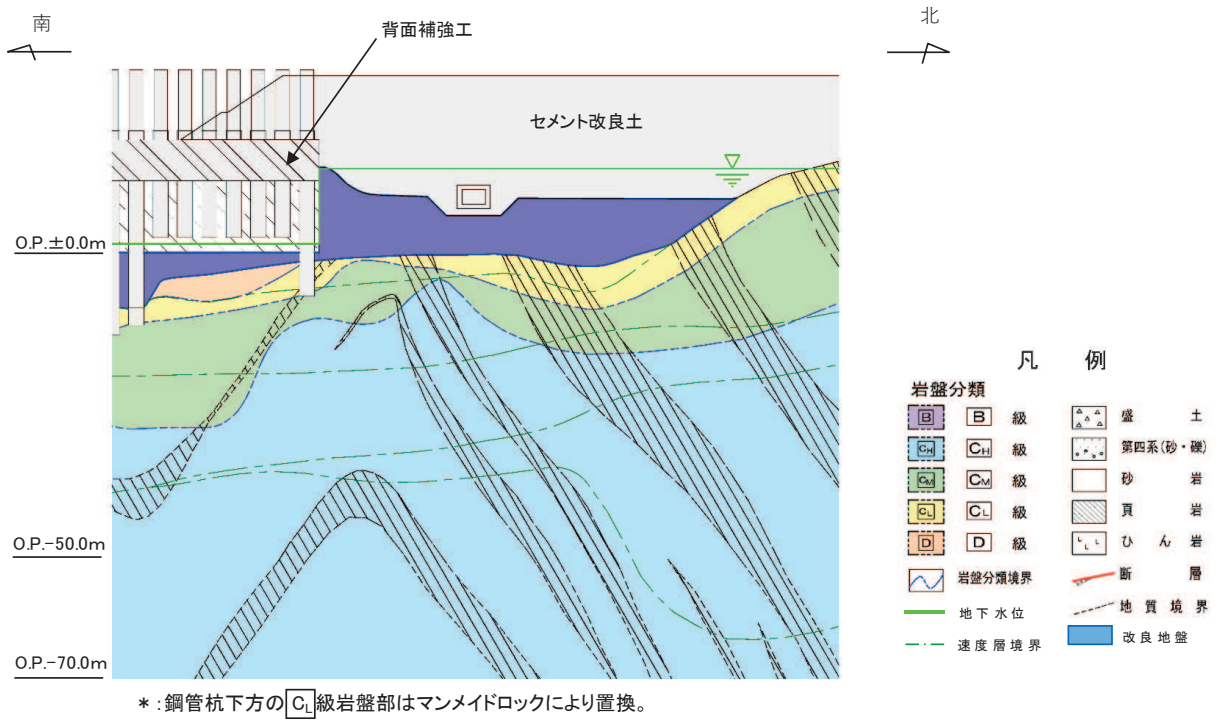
北側排水路の評価対象断面図 (A-A 断面)
